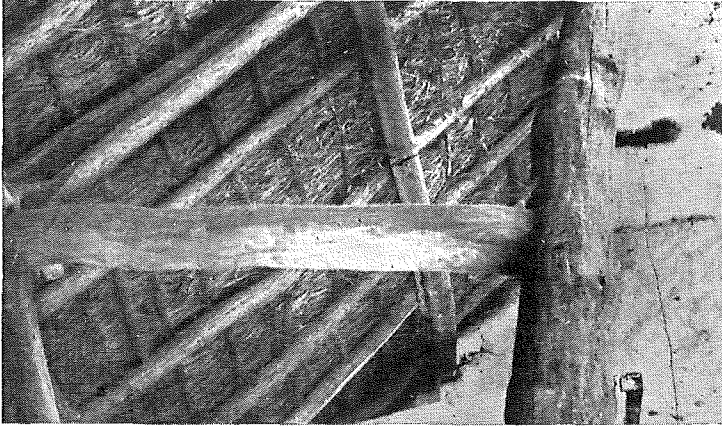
Haus 2: Dachgerüst mit Stroh-
